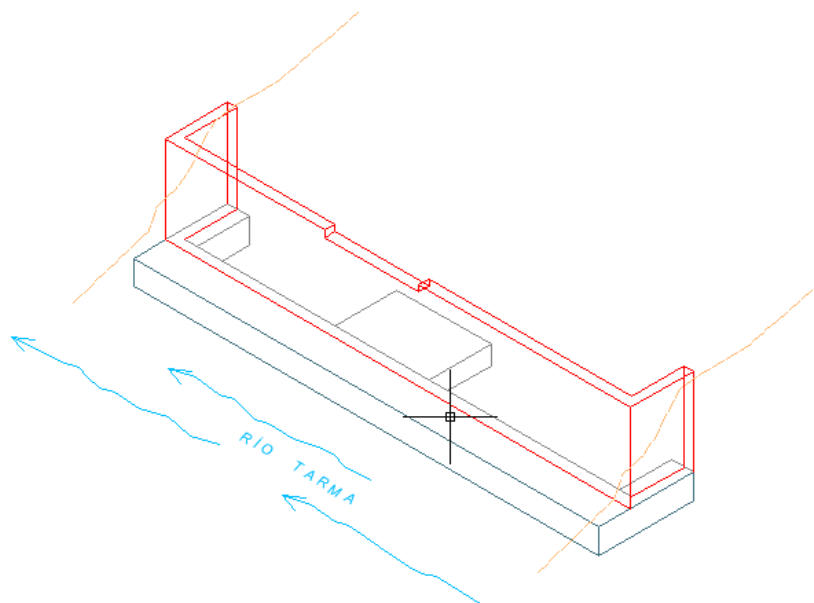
Encofrado de muros de contención ($A=94.00 \text{ m}^2$)
